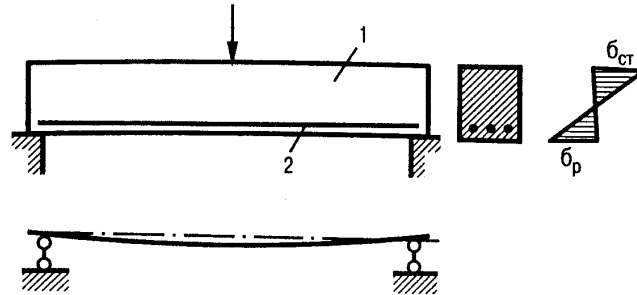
Схема роботи арматури в залізобетонній конструкції:
